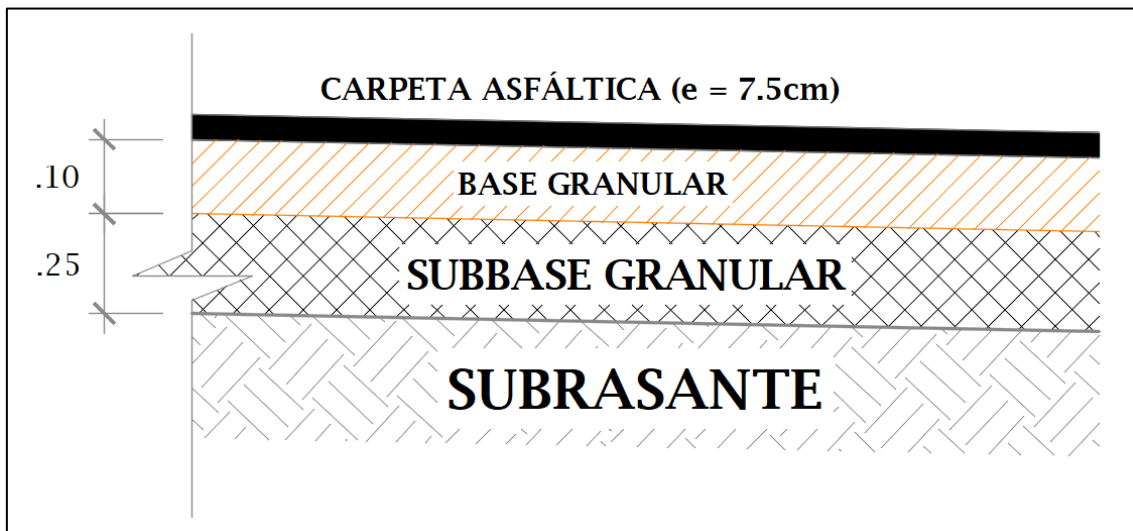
Sección de la estructura de pavimento diseñada (Elaboración Propia)
